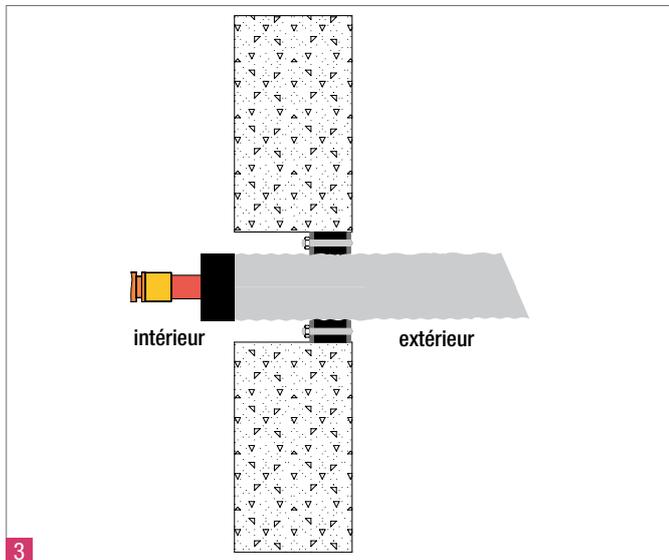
, Bride murale étanche FA 40 pour eau de ruissellement, vue latérale
